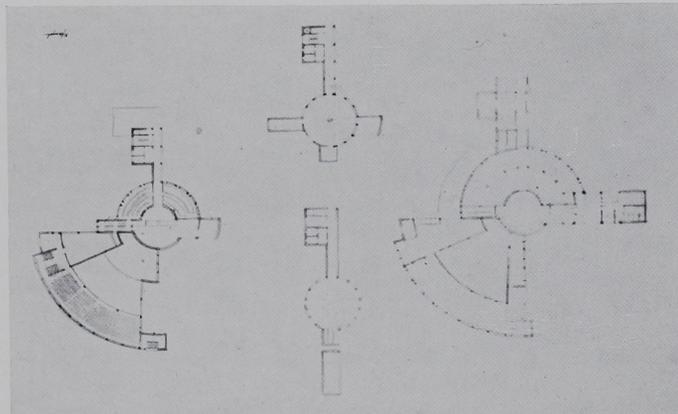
I. Lamzow, Entwurf für einen Klub. Grundrisse.
